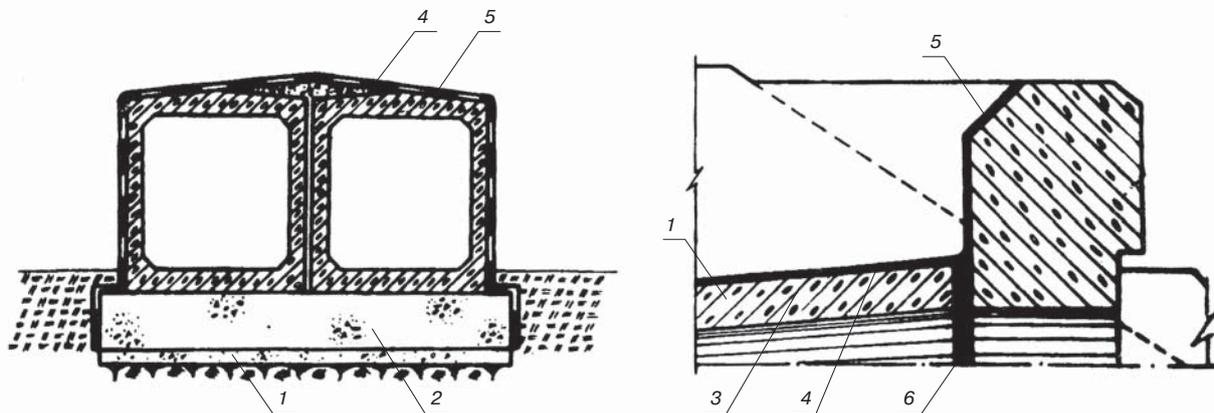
Конструктивные решения гидроизоляции и герметизации швов водопропускных труб под автомобильными дорогами: 1 – бетонная подушка; 2 – бетонный фундамент; 3 – железобетонная труба; 4 – грунтовка Абрис® Рп; 5 – гидроизоляция из одного или двух слоев Абрис® С-ЛТбаз или мастики Абрис® Рс (Ру), армированной базальтовой или стеклянной тканью; 6 – пакля, пропитанная Абрис® Рп
